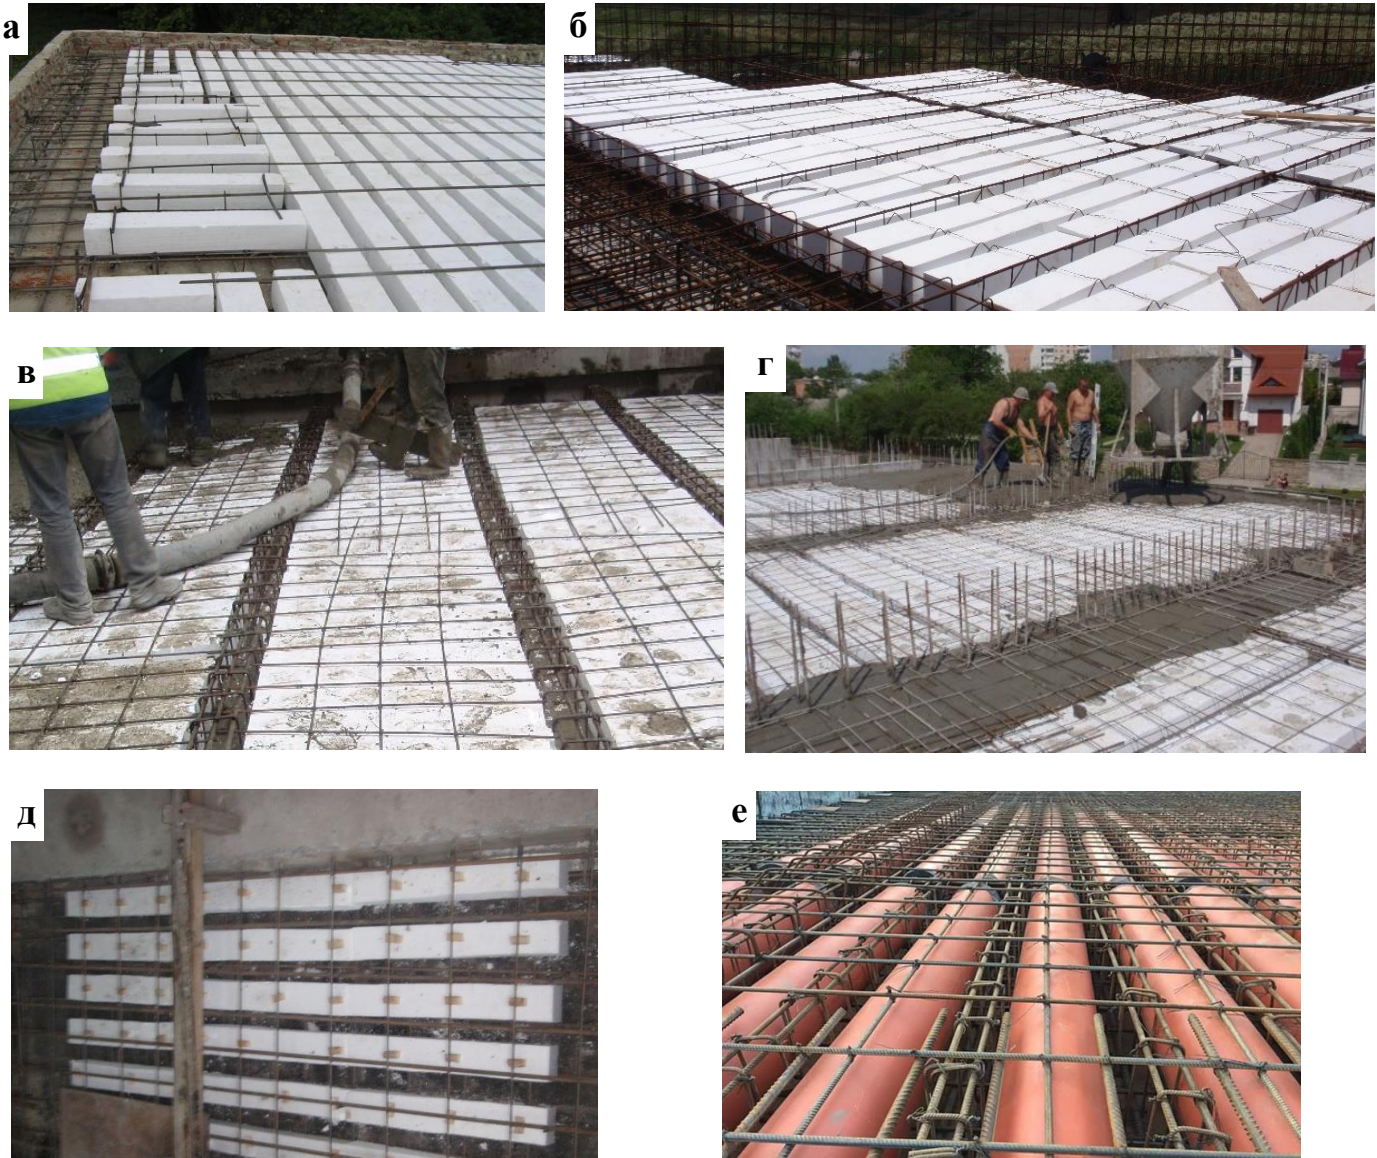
Загальні вигляди улаштування плитних конструкцій з вставками: а – перекриття будівлі в смт. В. Любінь Львівської області; б – перекриття на кутових ділянках будівлі стадіону Арена-Львів; в – перекриття паркінгу по вул. Роксоляни у м. Львові; г – перекриття типового поверху будинку по вул. Білогірській у м. Тернополі; д – фундаментальної плити при реконструкції будівлі по вул. Лемківській у м. Львові; е – моста у Свалявському р-ні Закарпатської обл.
